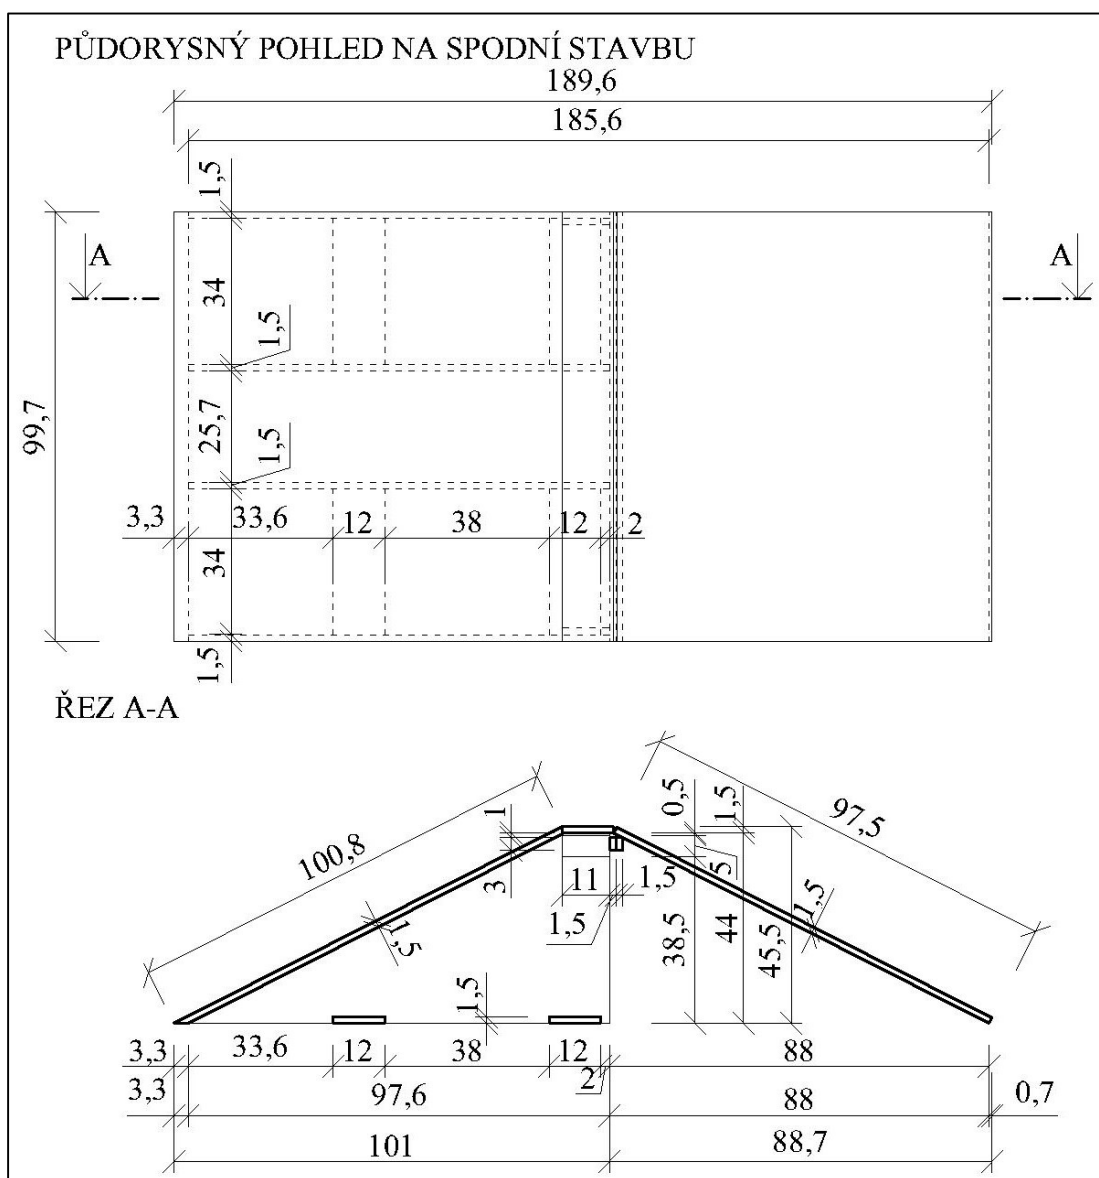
Půdorysný řez modelem a detail provedení přelivné hrany, kótováno v cm
